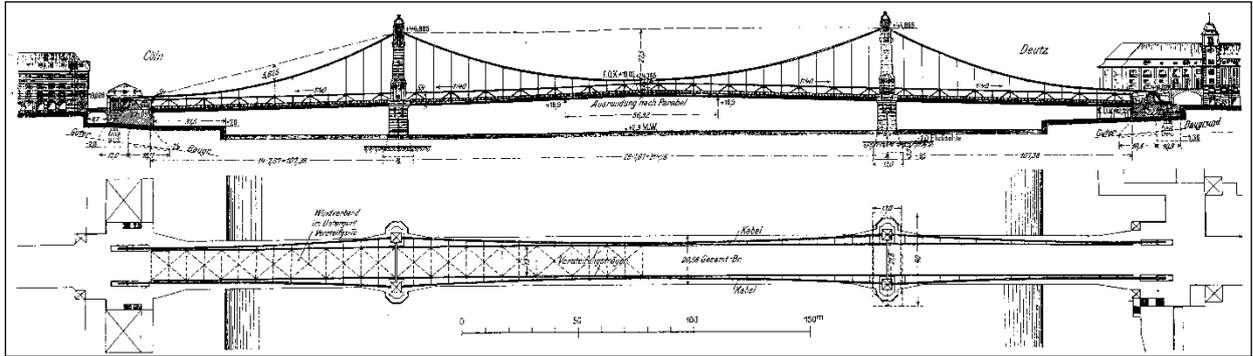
Wettbewerb von 1910/11 für die städtische Straßenbrücke. Entwurf „Alaaf Colonia“ (1. Preis). Verfasser: Gutehoffnungshütte, Oberhausen; Ph. Holzmann, Frankfurt a. M.; Architekt: Franz Schwechten, Berlin. Längsschnitt und Grundriss.
